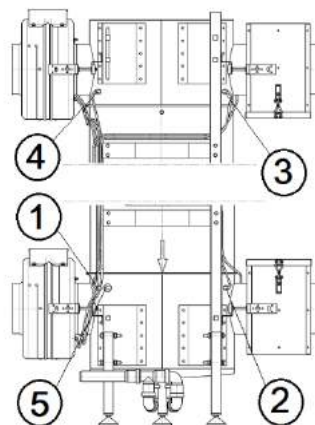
Miejsce oznakowania przeznaczenia instalacyjnego króćca przyłączeniowego
